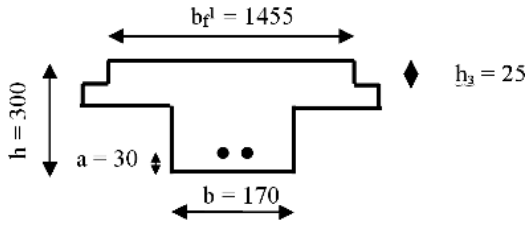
Расчетное сечение ослабленного продольного ребра при заделке креплений на глубину 25 мм
